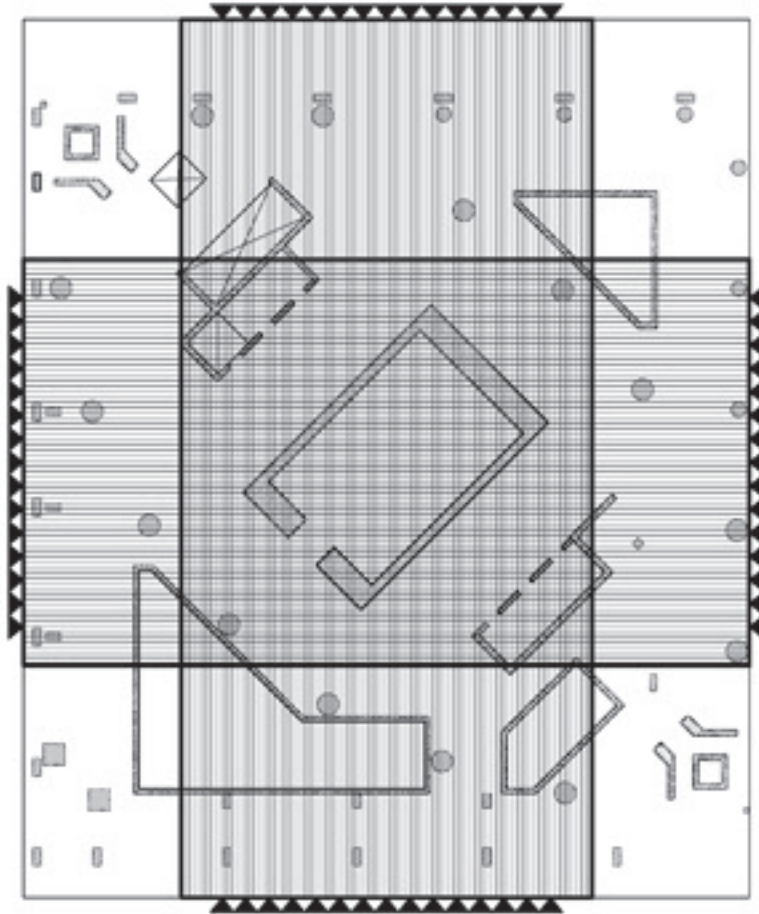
Esquema con la distribución de cables de pretensado en la losa de cimentación.
